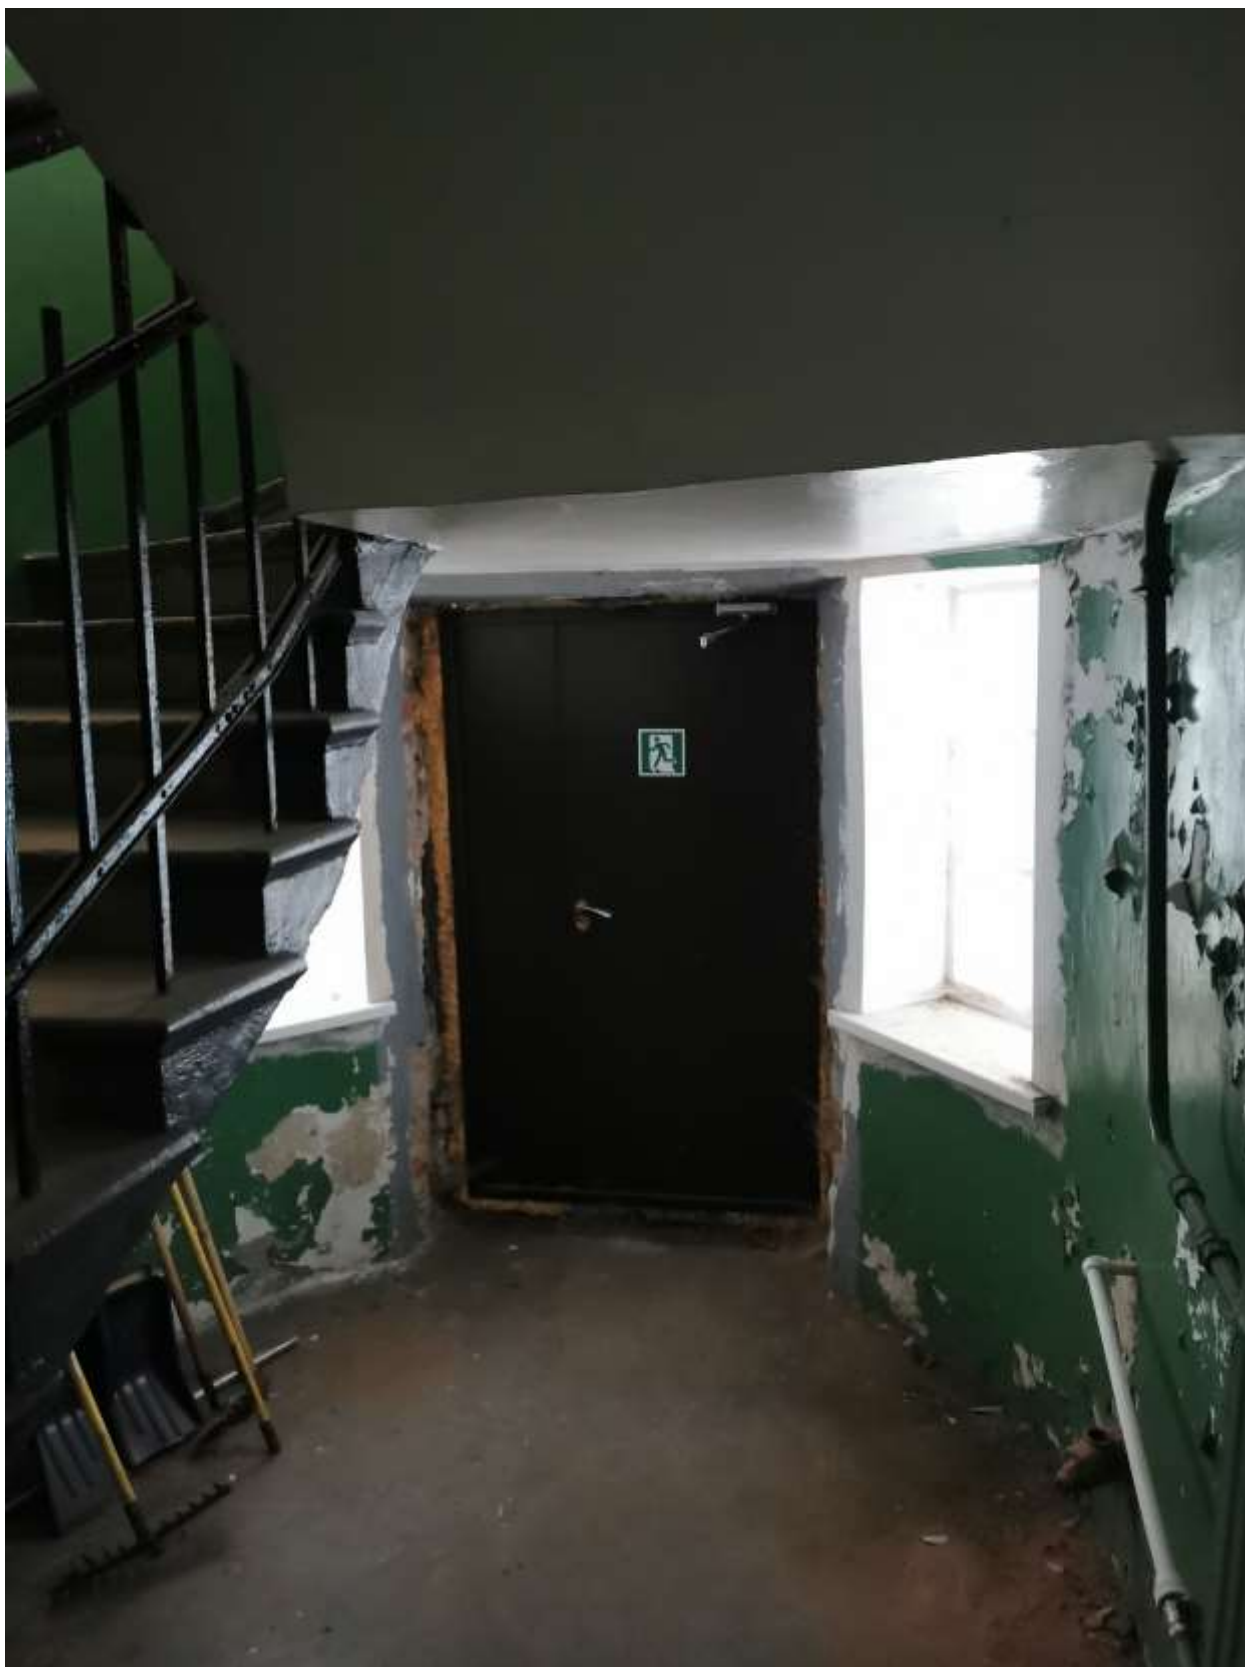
Вид на лестницу (вход со стороны южного фасада)
